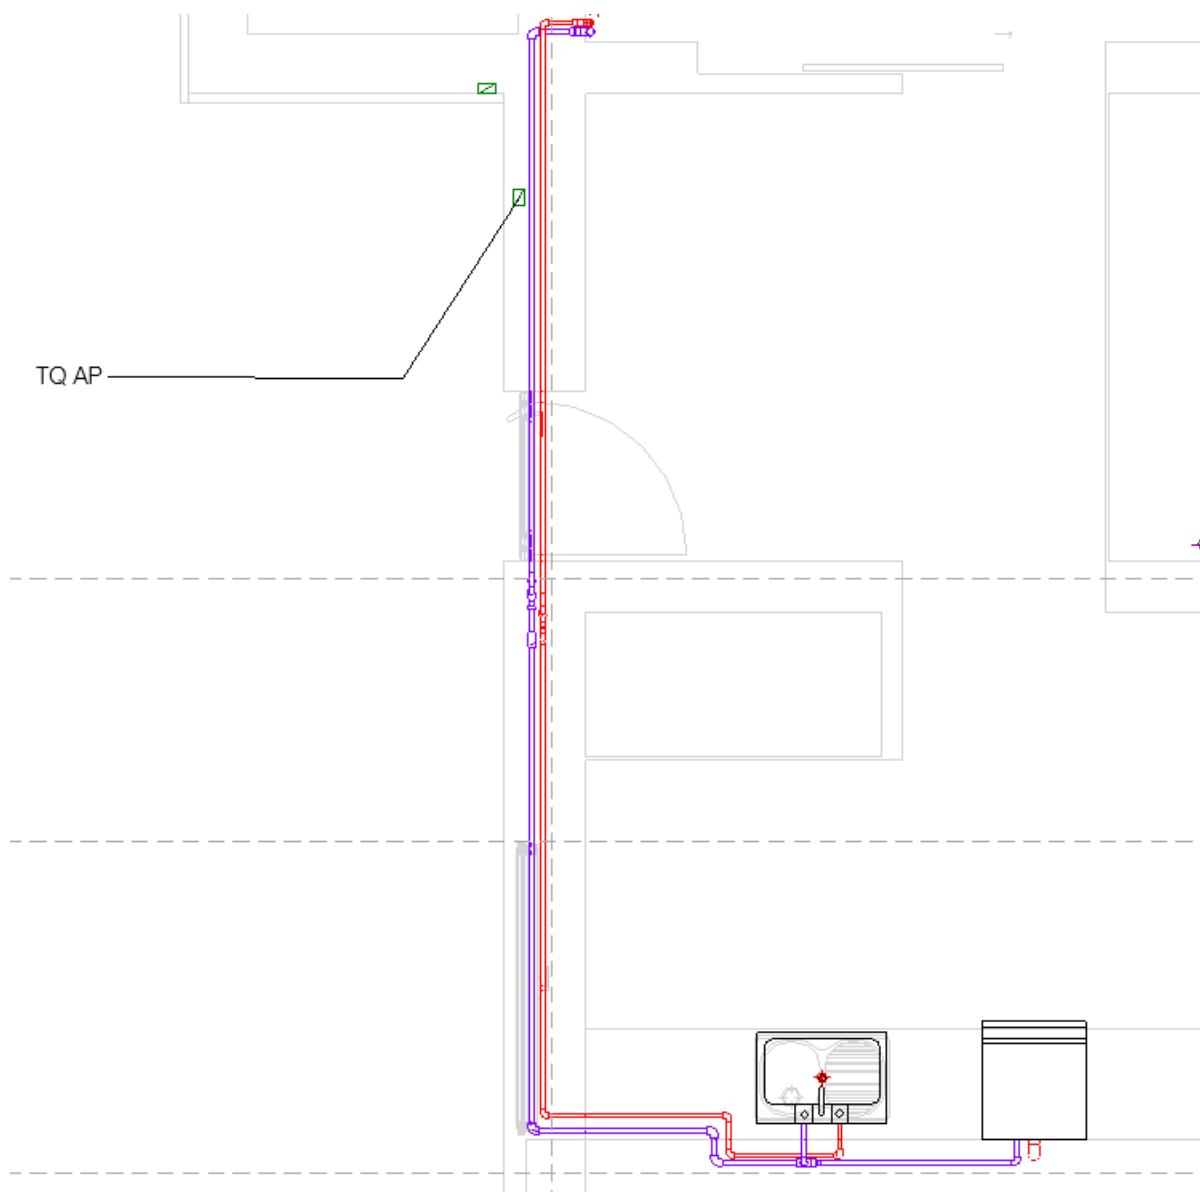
Divisão (2) em planta do piso 1 da rede predial de abastecimento
